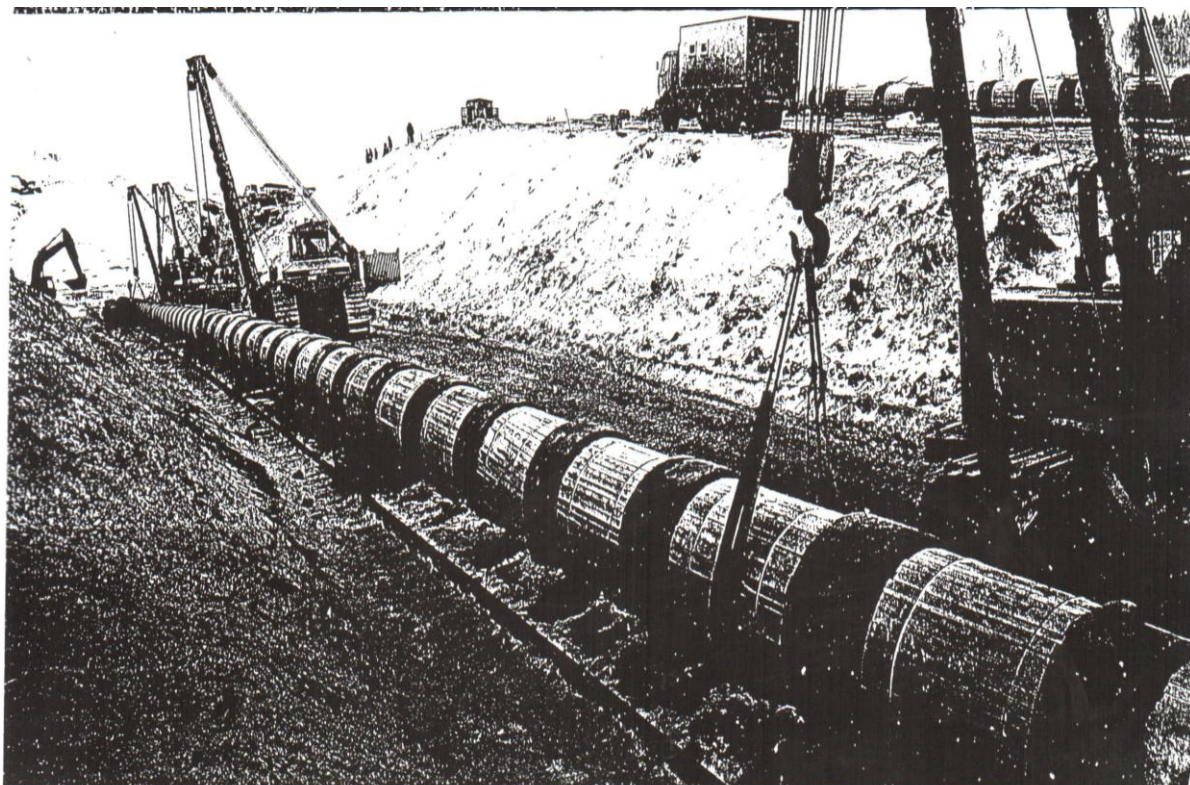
Подготовка трубопровода к переходу через водную преграду
